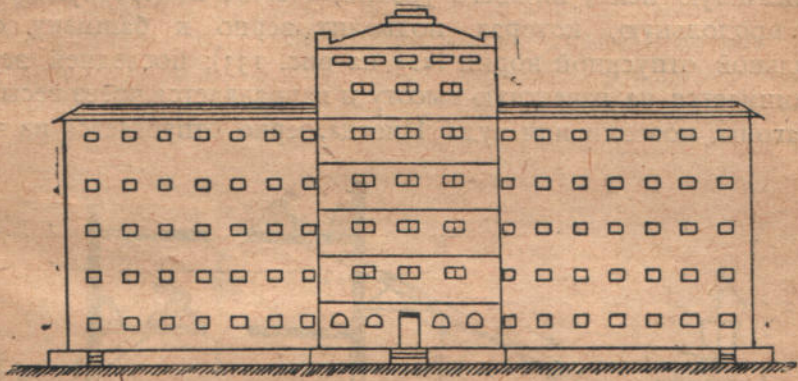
Устройство средней поперечной части корпуса элеватора возвышающейся над боковыми частями.
